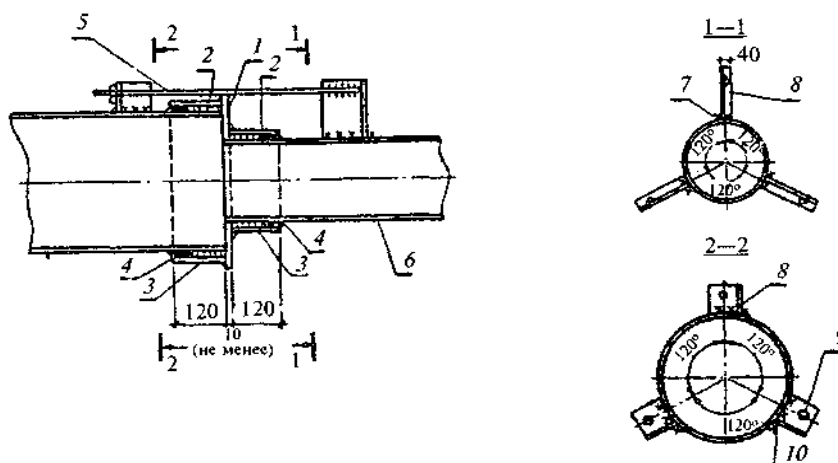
Схема соединения труб разных диаметров при помощи сварного перехода
